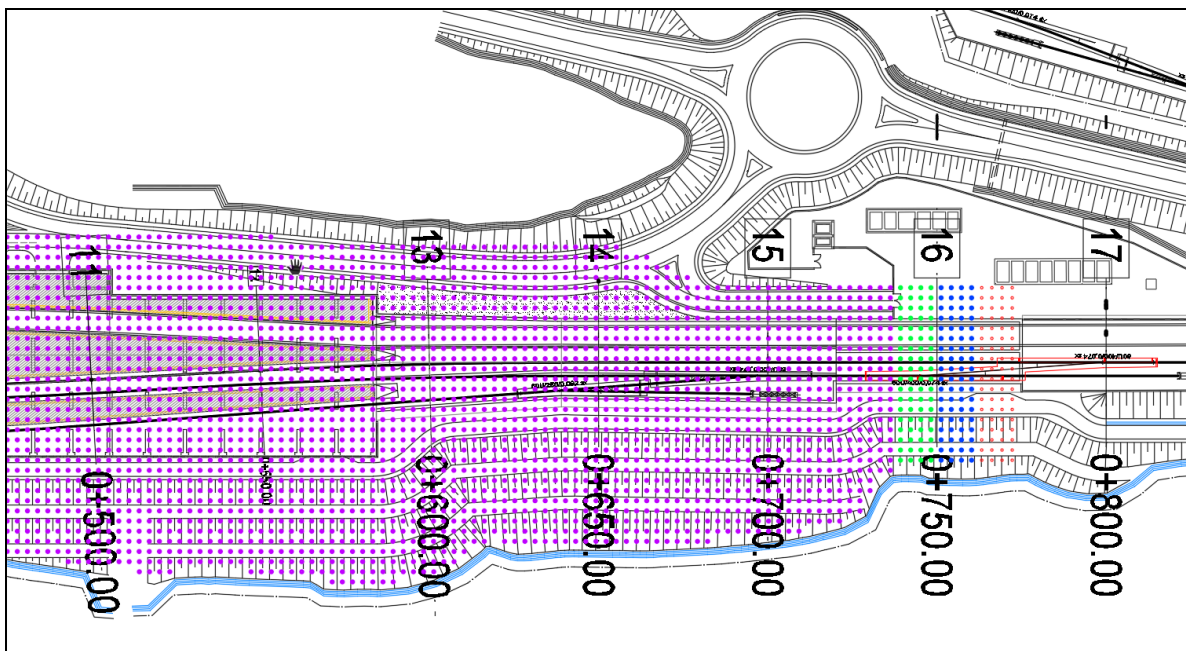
Porzione planimetrica implementata nel modello tridimensionale
